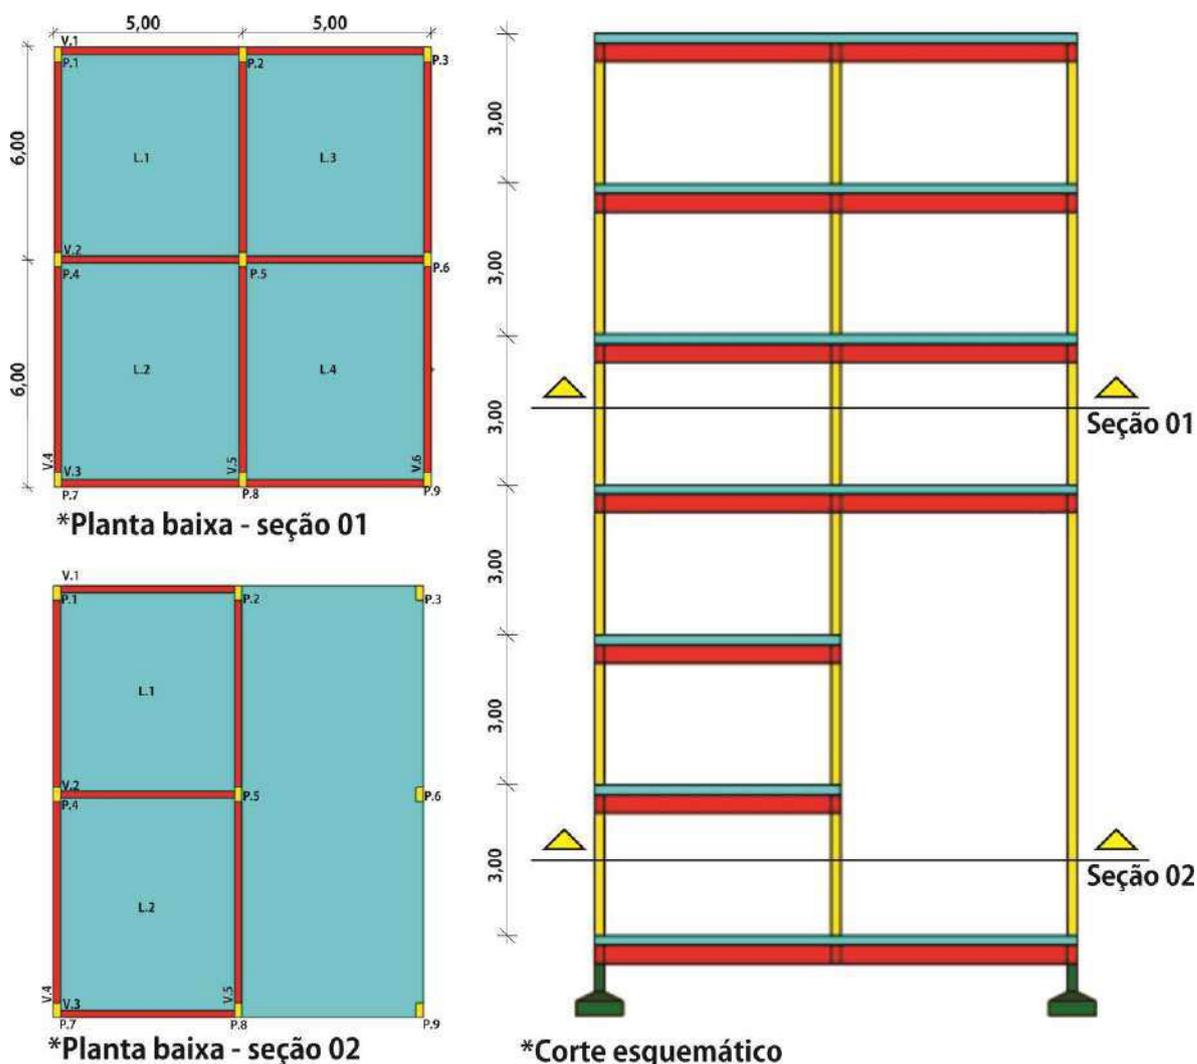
Exemplo 02 – Plantas baixas e corte
